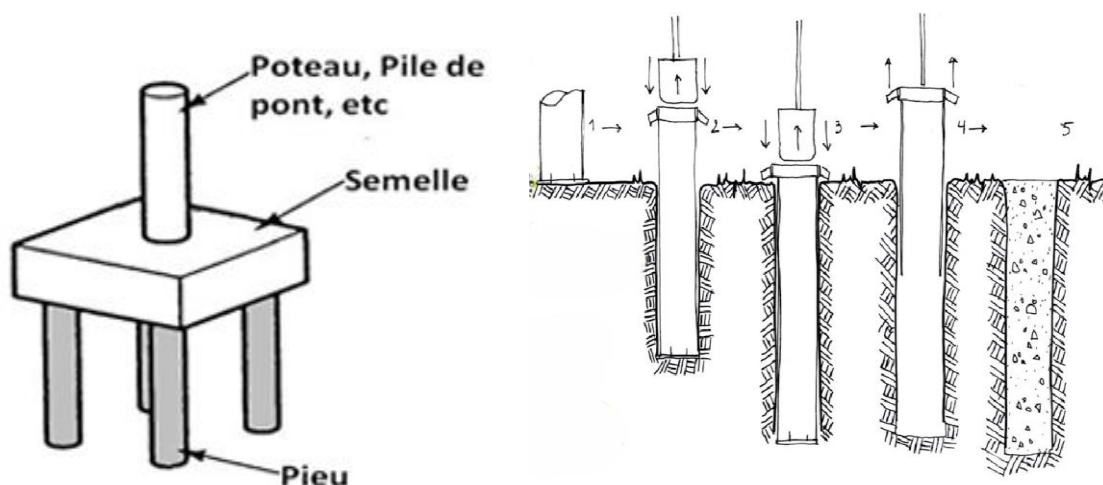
Schéma de fondation d'un pont sur pieux
